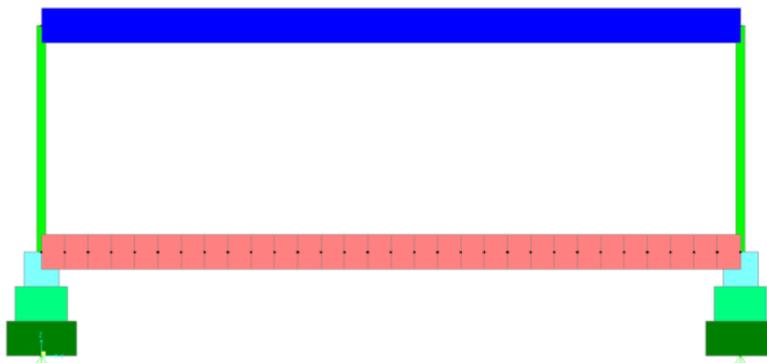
Vista do Modelo SAP a laje da sobreloja (Fonte: Autora)
